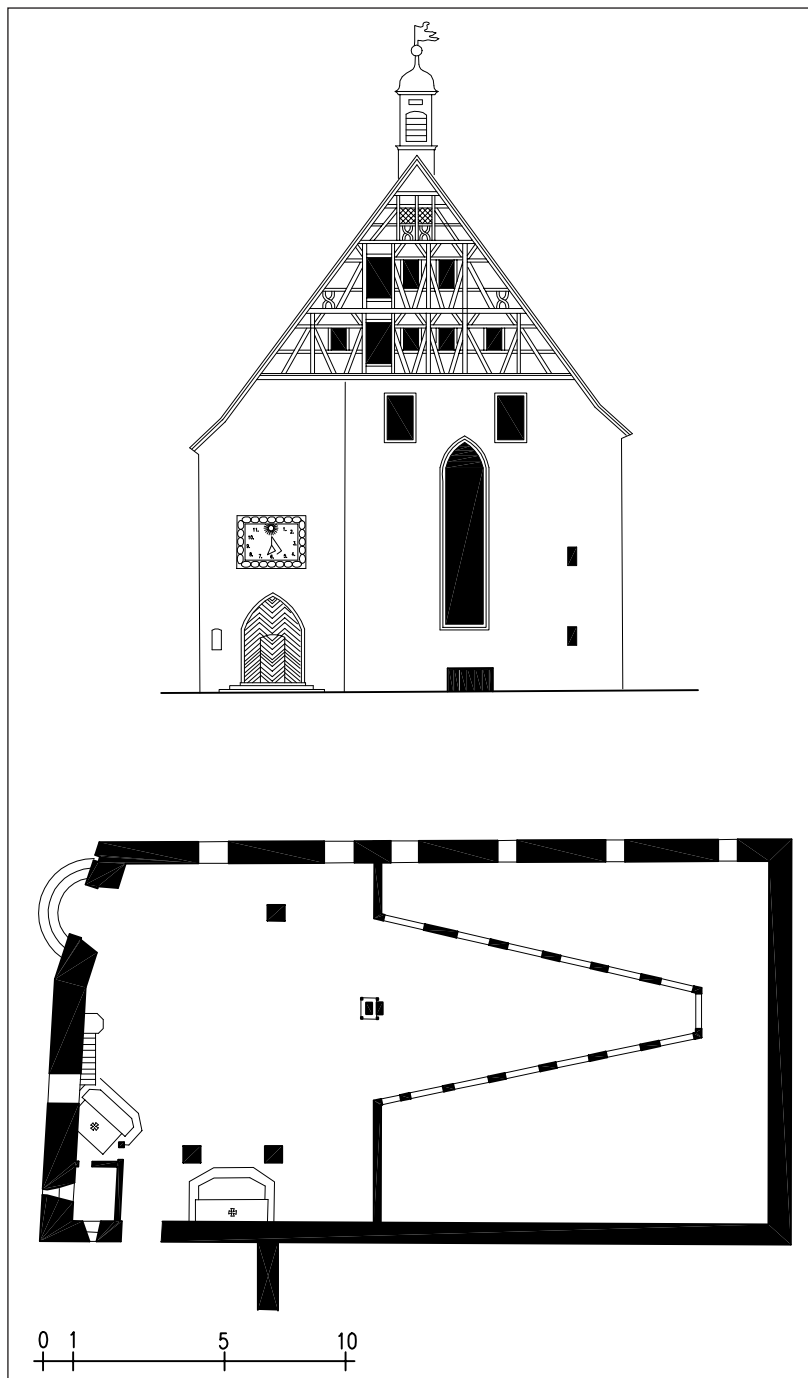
Schwäbisch Gmünd. Abgegangene Spitalkirche, Südfassade und Grundriss von W. Franz 1823.
